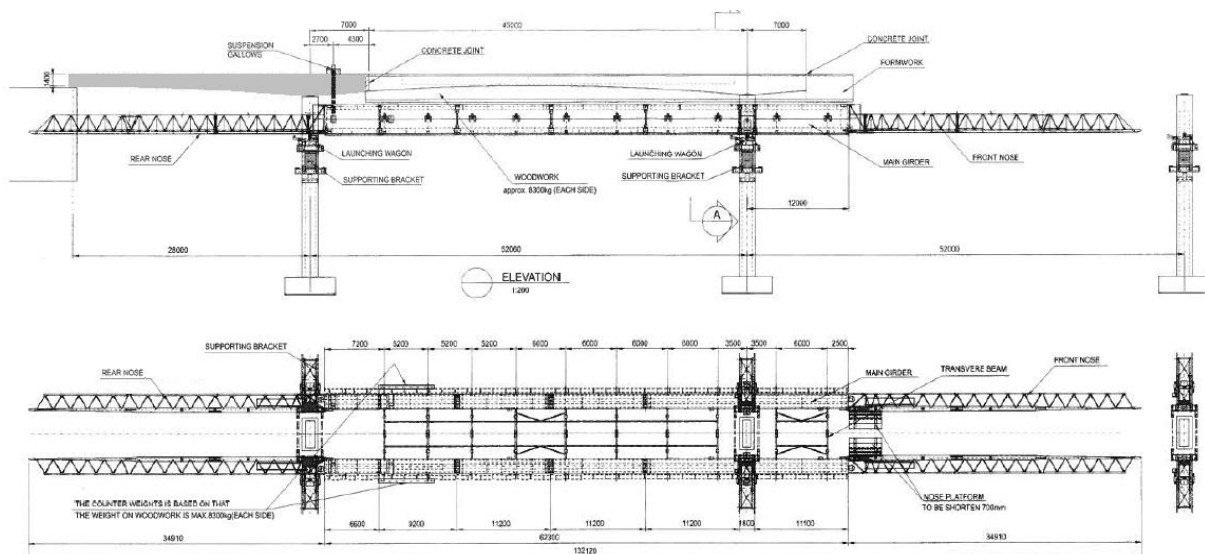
Planta e Alçado da Viga de Lançamento, (Viaduto 1).
